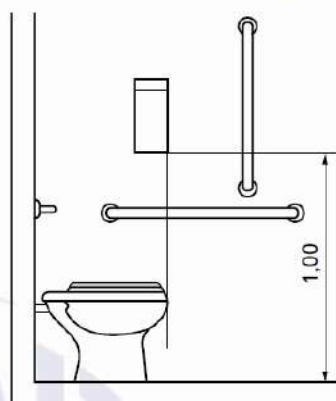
Localização da papelreira de sobrepor (interfolhado) – Vista lateral
